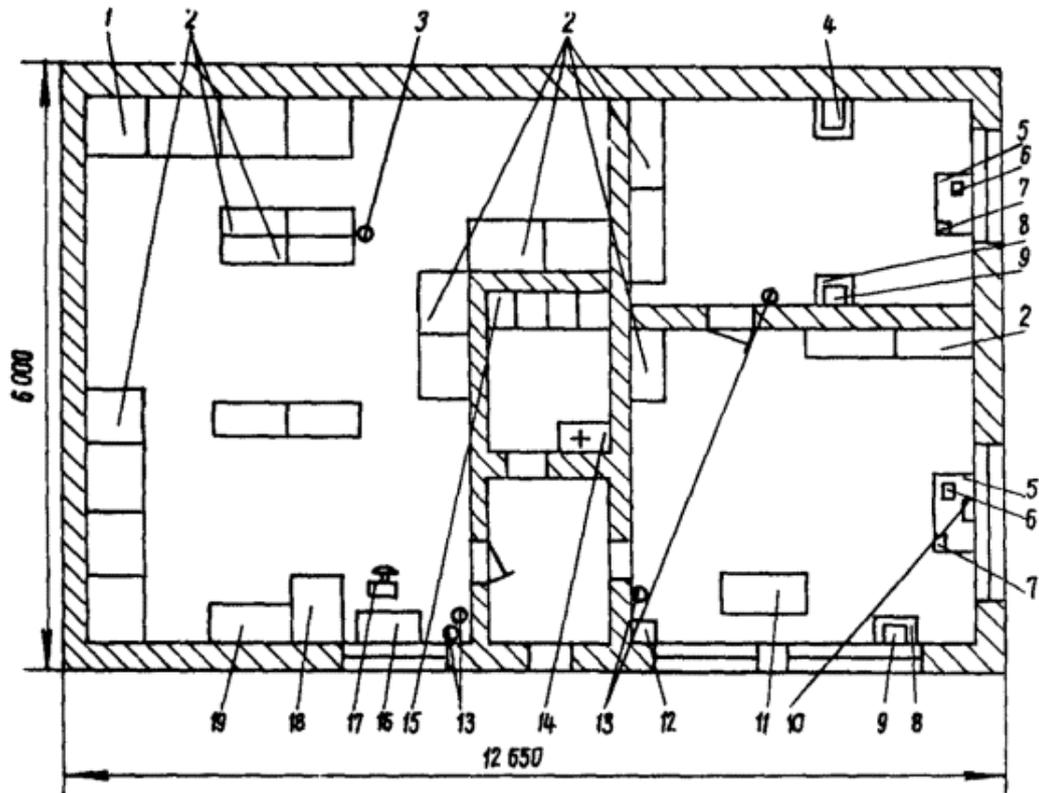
Центральная инструментальная кладовая: 1 – стеллаж для абразивного инструмента; 2 – стеллаж с поддонами для электрических и пневматических ручных машин, средств малой механизации; 3 – стеллаж для мелкого режущего инструмента; 4 – стенд для испытания редукторов, манометров и резаков после ремонта; 5 – верстак; 6 – тиски В-120; 7 – заточный станок; 8 – тумбочка для настольно-сверлильного станка; 9 – настольно-сверлильный станок; 10 – гребенки для подключения пневматических ручных машин; 11 – токарно-винторезный станок с высотой центров не менее 100 мм; 12 – стенд для проверки электроинструмента СПЭИ-2; 13 – огнетушитель химический пенный ОП-5; 14 – умывальник; 15 – шкаф для одежды; 16 – стол конторский двухтумбовый; 17 – стул специальный с регулируемой высотой сиденья; 18 – сейф; 19 – стеллаж с дверками для измерительного, режущего дорогостоящего инструмента и приборов
